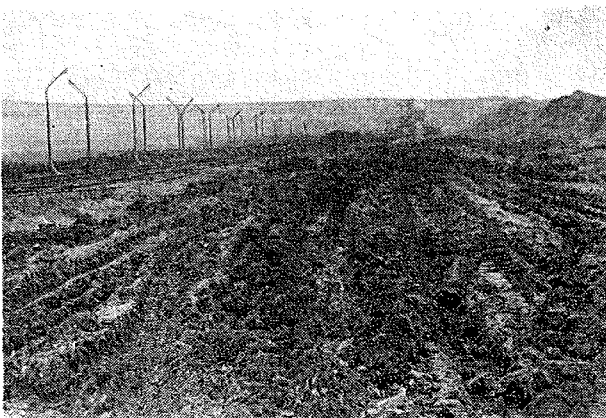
Aspetto del terreno prima della stabilizzazione.
